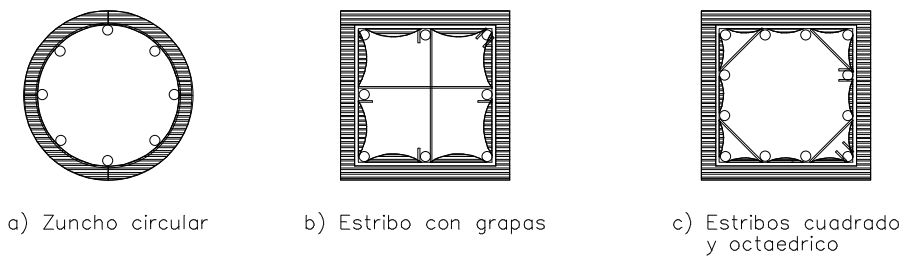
Vista en planta y elevación del confinamiento según la distribución de estribos, grapas y del acero longitudinal
